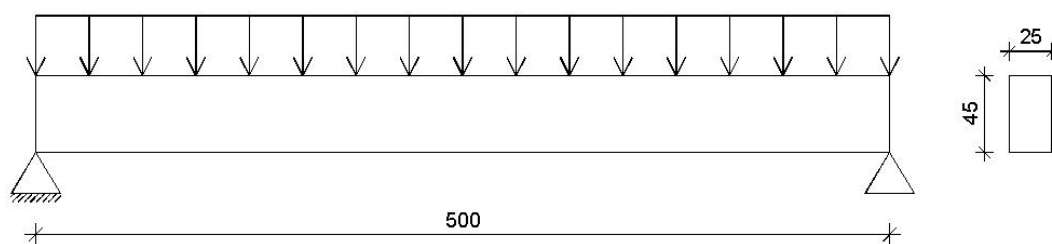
esquema da viga bi-apoiada e seção transversal (cm)
